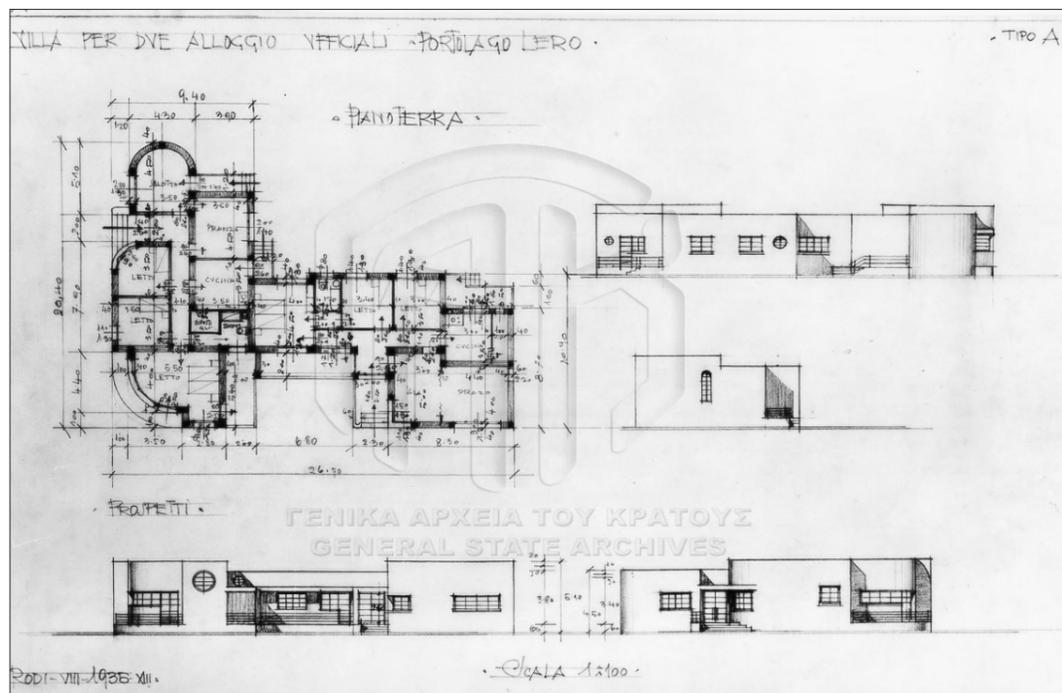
casa ufficiali A, pianta pt e prospetti sc. 1:100
